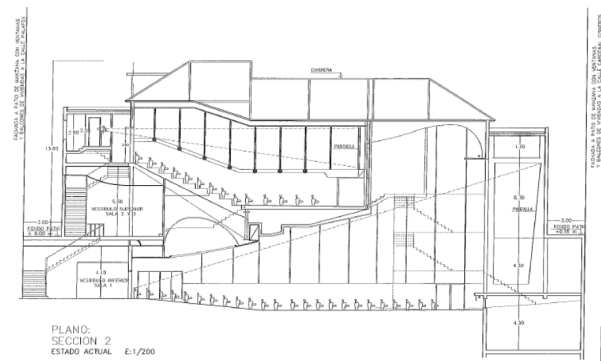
Alzado Longitudinal estado existente pre-reforma, Cine Palafox
